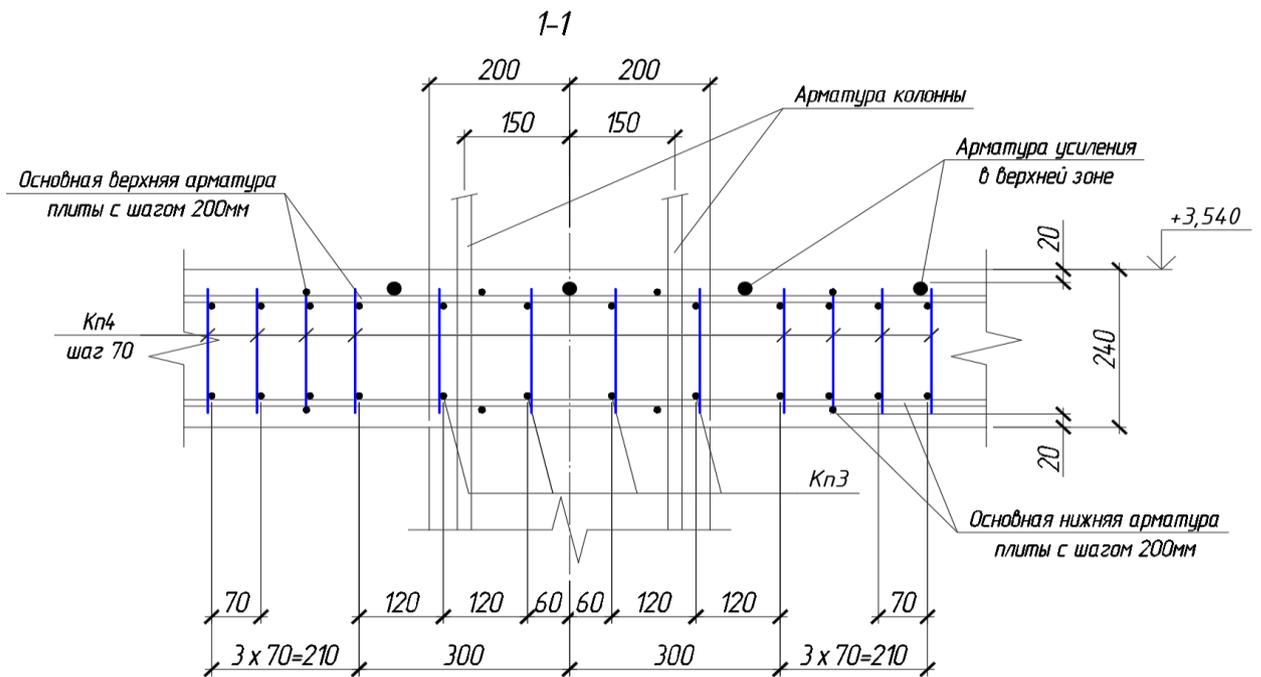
Разрез 1-1 по узлу поперечному армированию
